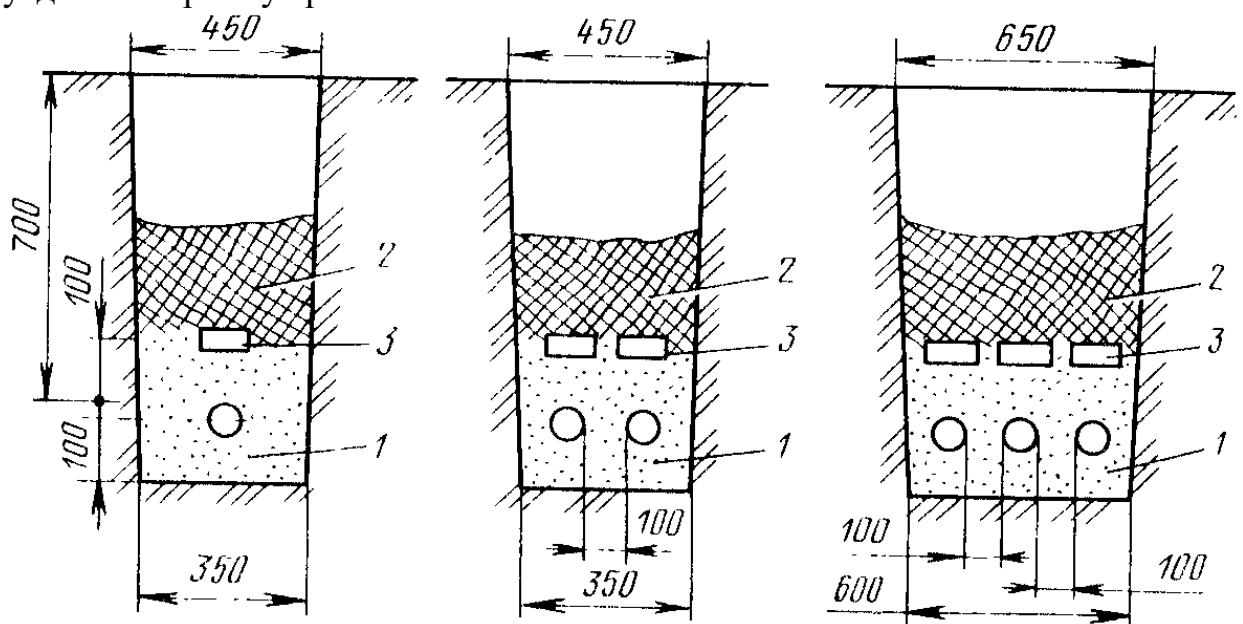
Переріз траншеї для прокладки кабелю напругою до 10 кВ: 1 – пісок або просіяна земля; 2 – ґрунтова земля; 3 – цегла
